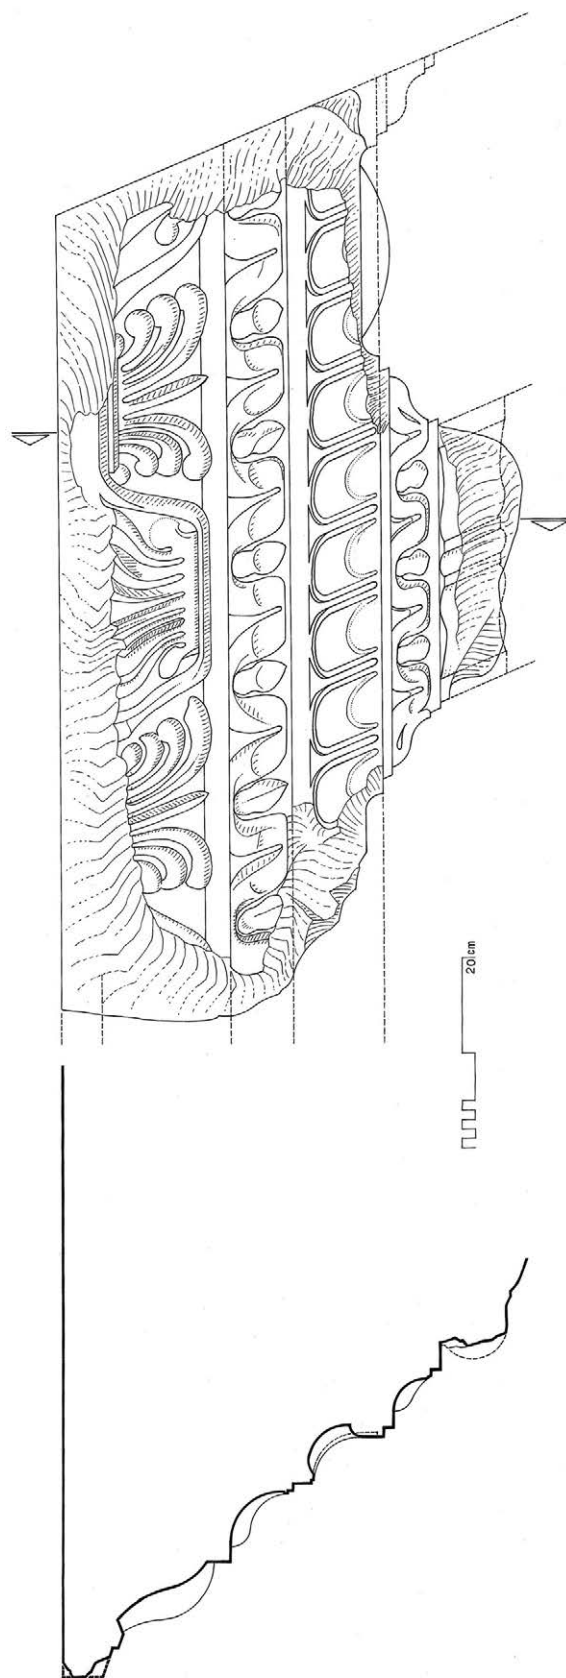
Temple A. Élévation et coupe de l'élément intermédiaire R.74.401 du rampant de droite du fronton (G. Hallier).
